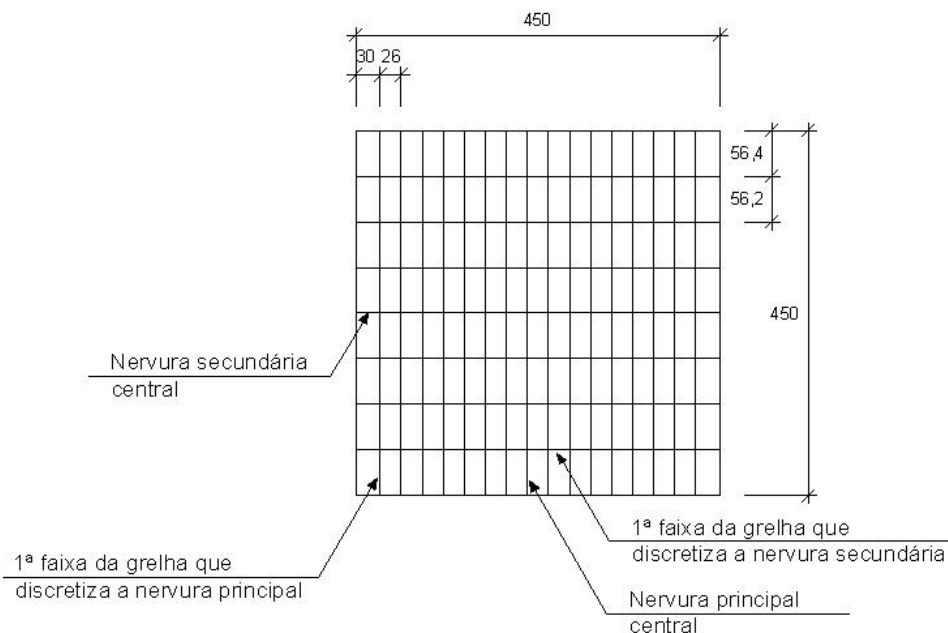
Posicionamento das faixas da grelha para a laje com 7 nervuras secundárias
